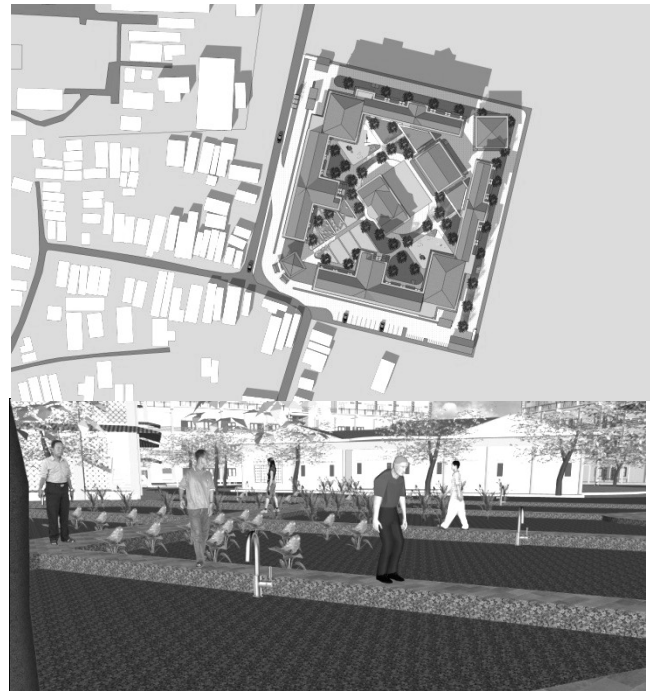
Penerapan tema “Jalinan” pada bangunan
